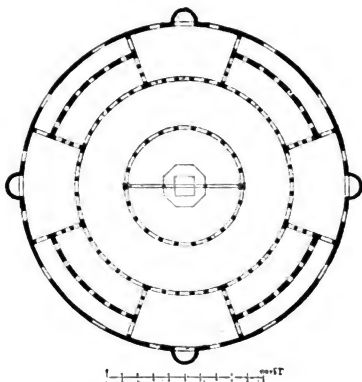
St. Stefano rotondo in Rom. Grundriss.
